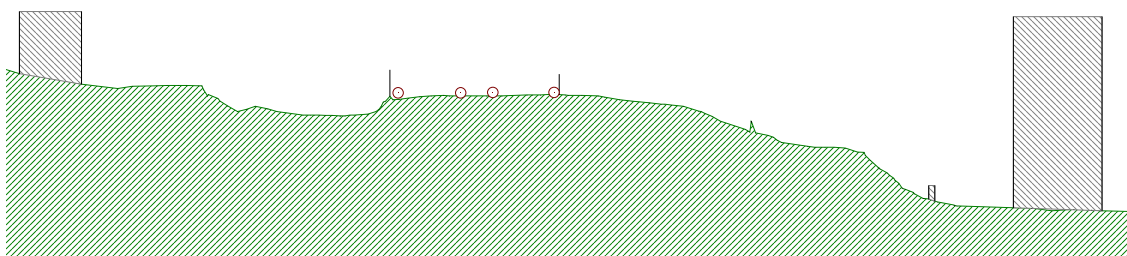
Esquema de Implantação das Barreiras Acústicas 4 e 5
